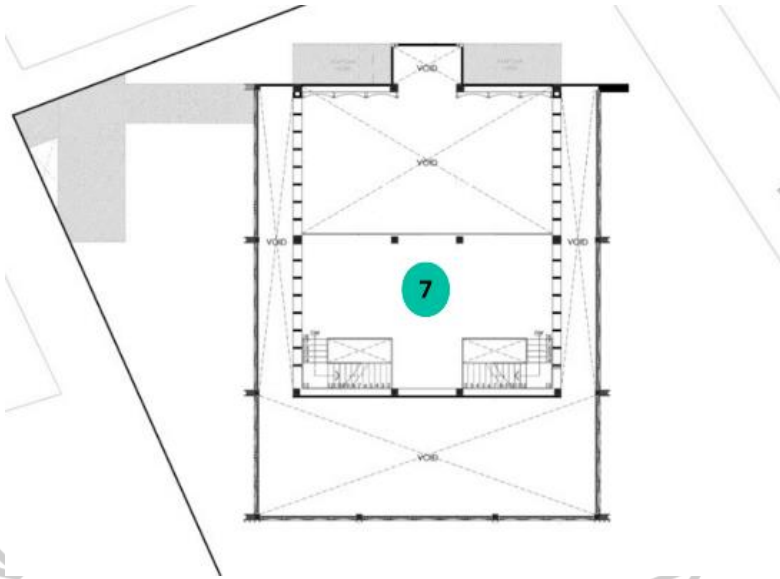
2 Denah Lantai 1 Masjid Jami' Al-Hurriyah
